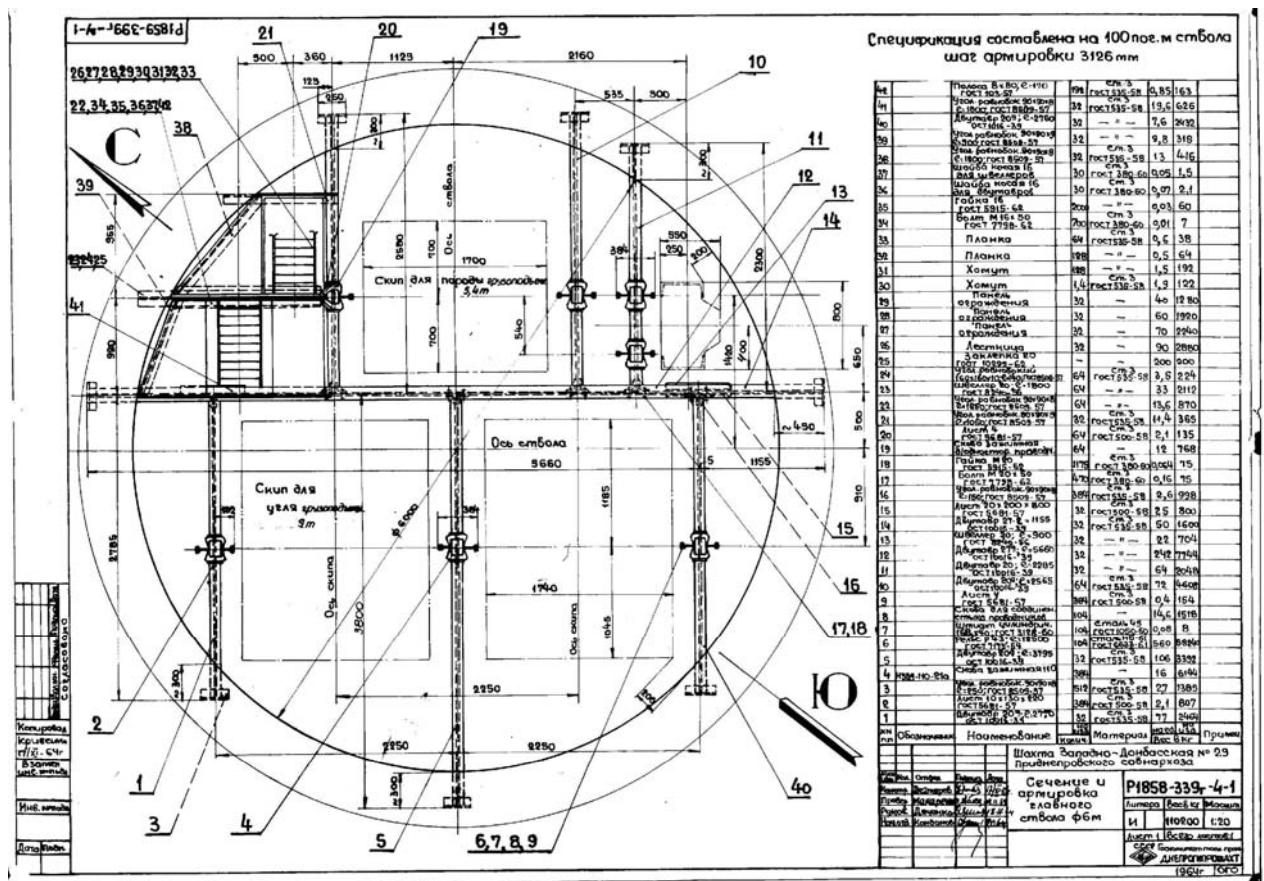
Копія оригінала робочого креслення перерізу скіпового ствола
